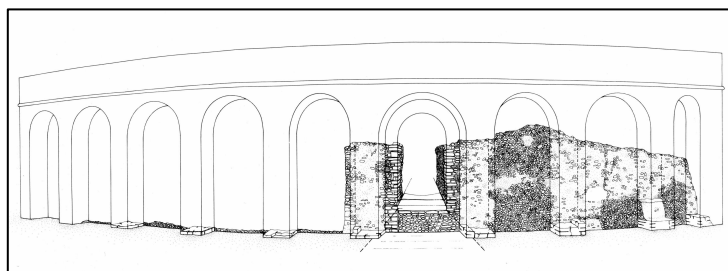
Ricostruzione del prospetto esterno del teatro in età repubblicana
